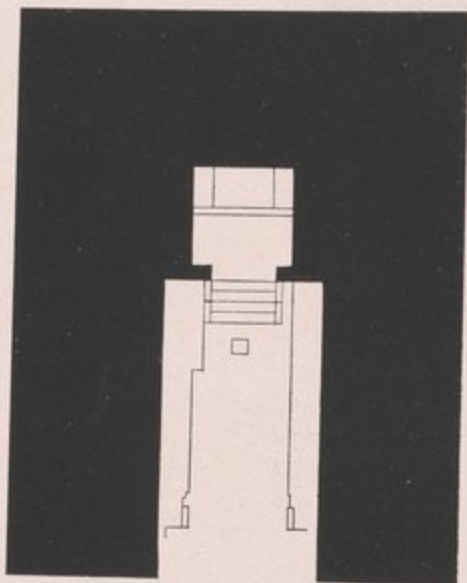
Suk-el-Wardian. Grundriss.
